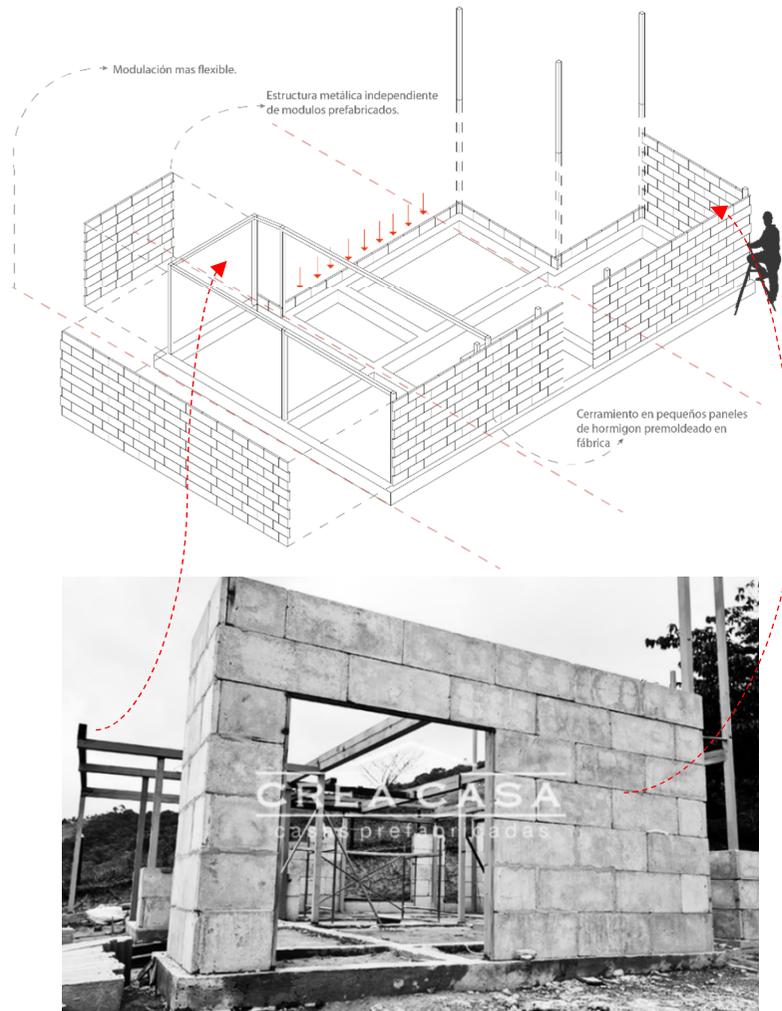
imagen de casa con sistema prefabricado de módulos de pequeño formato en hormigón
